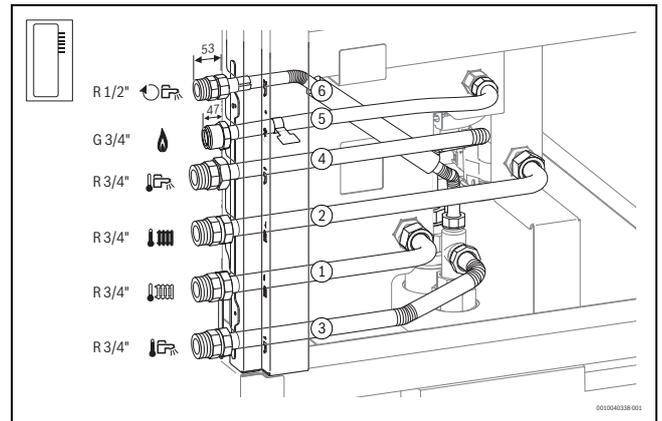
Vue côté arrière (dimensions en mm) : accessoire CS 10 FR-5300 monté sur le côté droit
